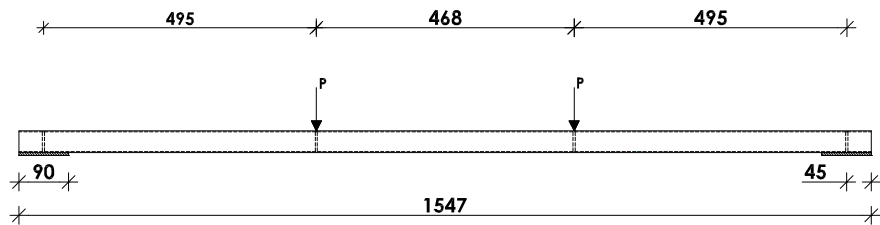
Alçado do ensaio tipo 150×1.5\_Fz2\_Liso (dimensões em mm).
